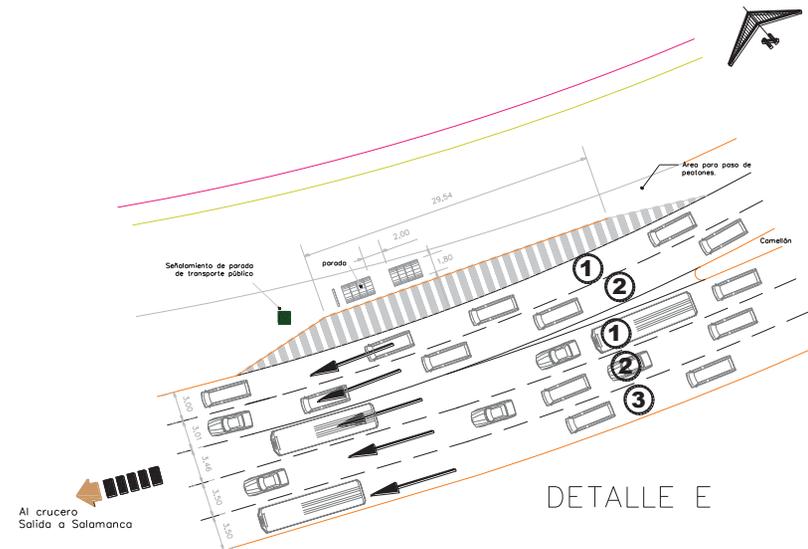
Detalle de parabus ubicado en la zona de estudio.
